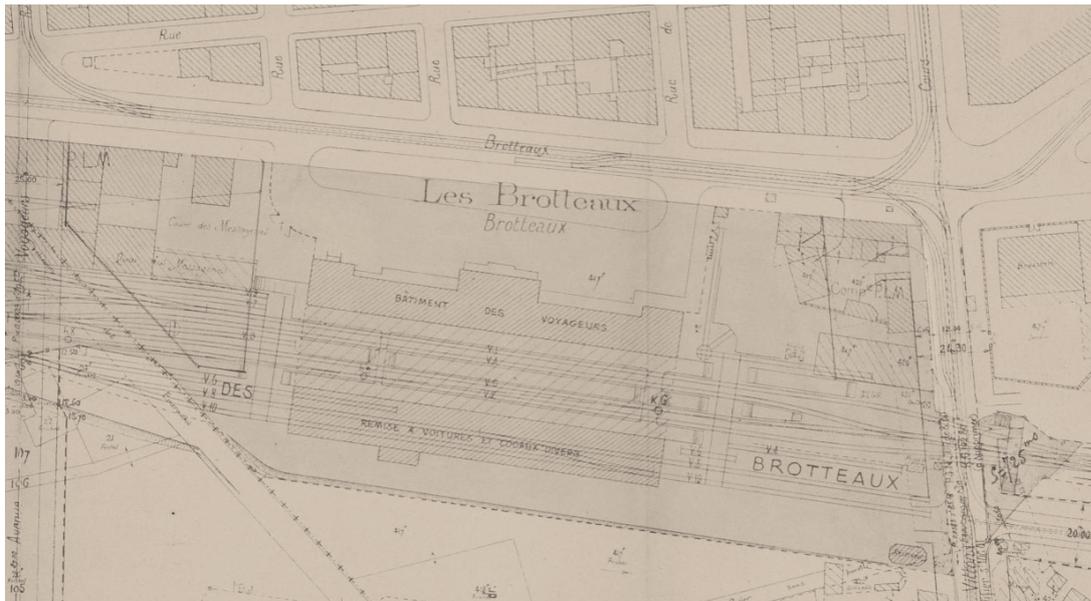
Extrait d'un plan de situation montrant la première gare des Brotteaux (©SNCF)
